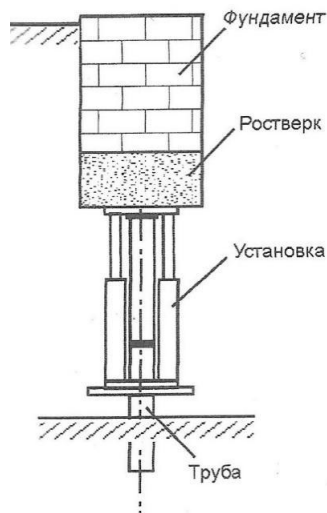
Підсилення фундаментів з-під підшви будівлі
